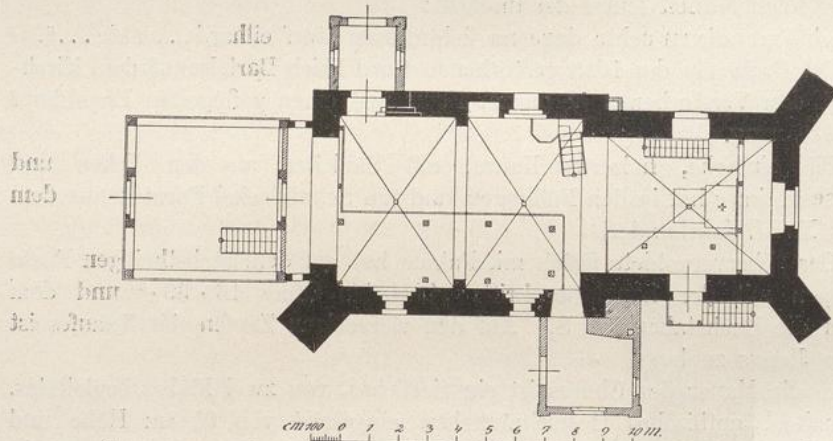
Kirche in Meinerdingen; Grundriss
